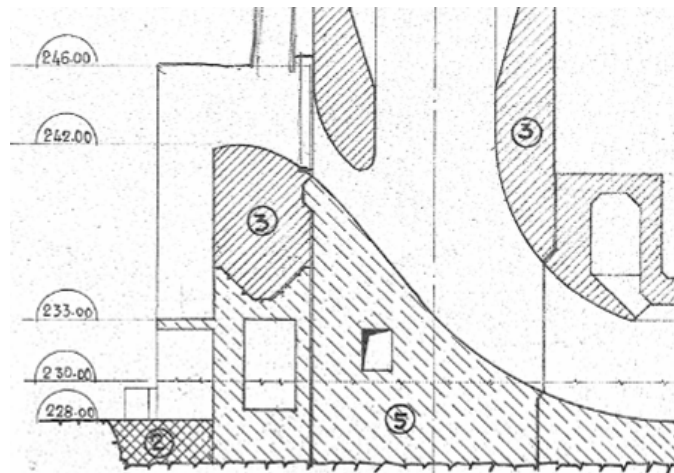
Coupes longitudinale et latérale de la tulipe
